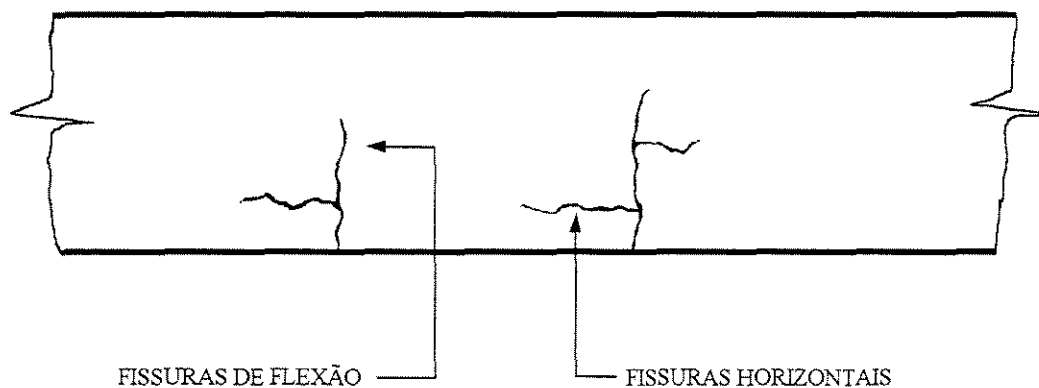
FISSURAS HORIZONTAIS
